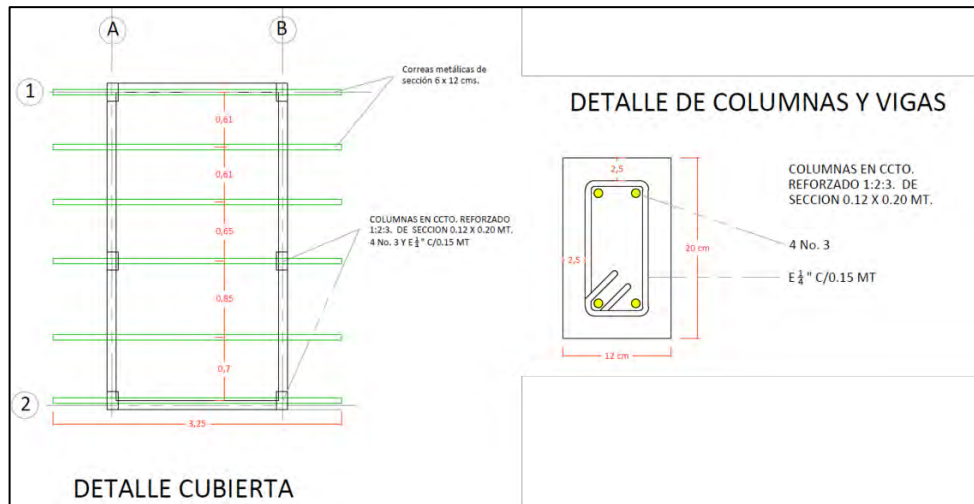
Detalle de cubierta, vigas y columnas de la caseta de vigilancia
